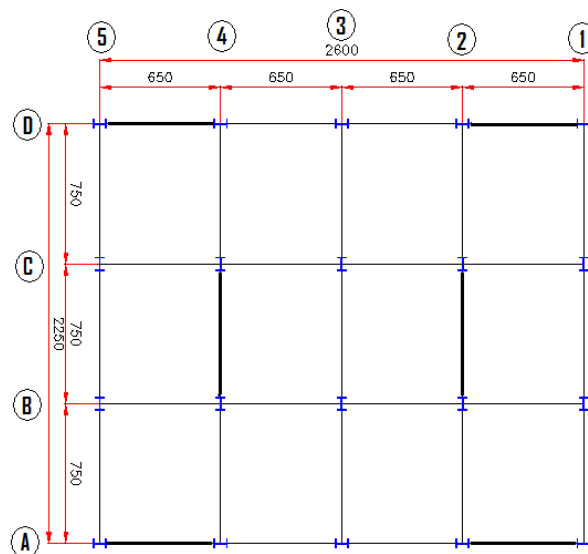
Dimensiones (cm). Planta Edificio de 3 Niveles.
